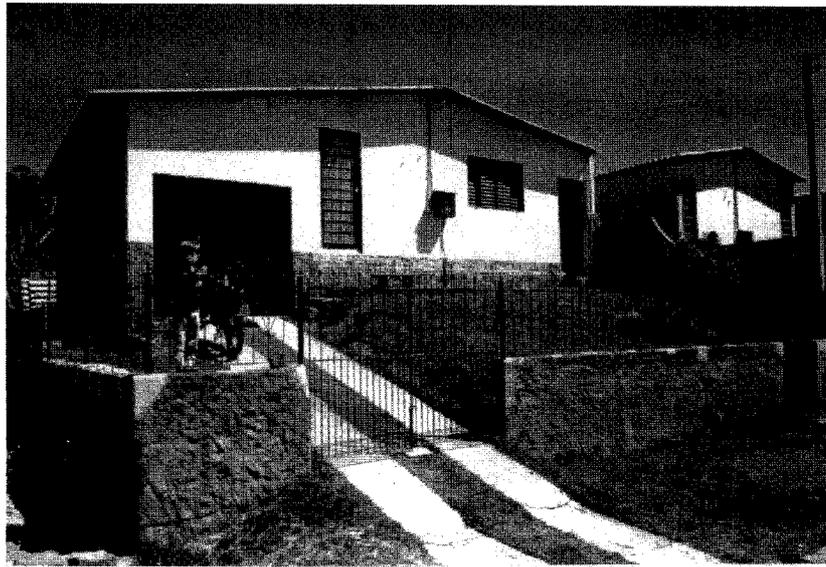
Casas isoladas no terreno - Tancredo Neves
